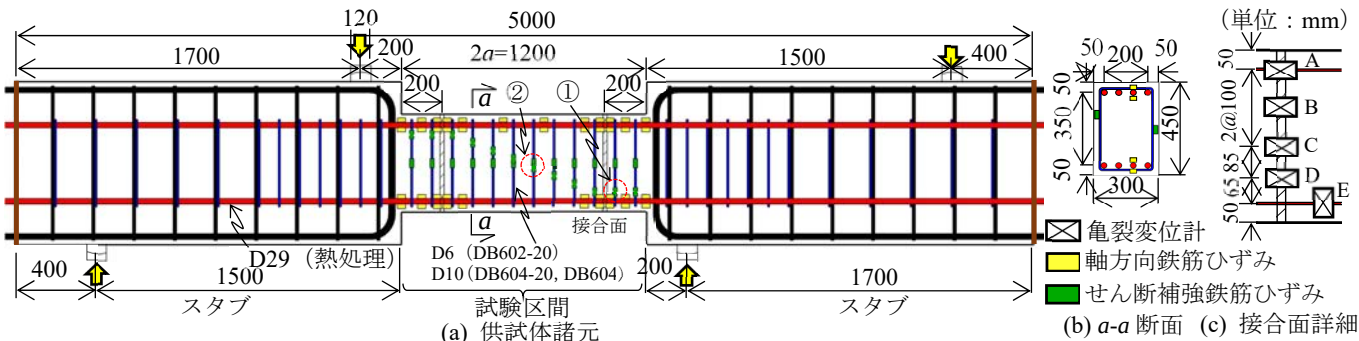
供試体諸元と計測位置 (DB602-20, DB604-20)
